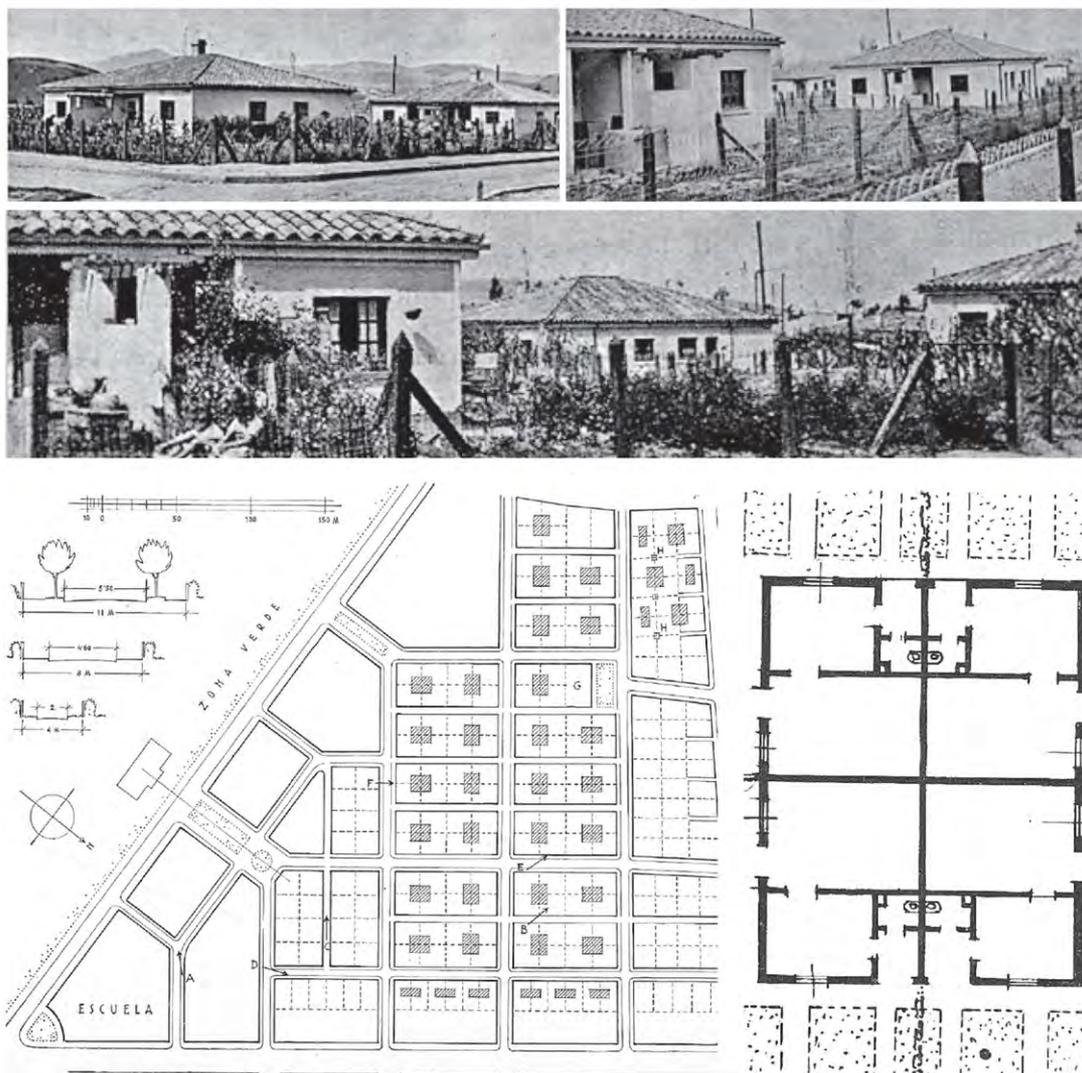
Fotografías, plano general y planta de casa tipo del barrio Centenario, en su primera etapa de construcción. Brunner, 1940, p.132 y 133.
